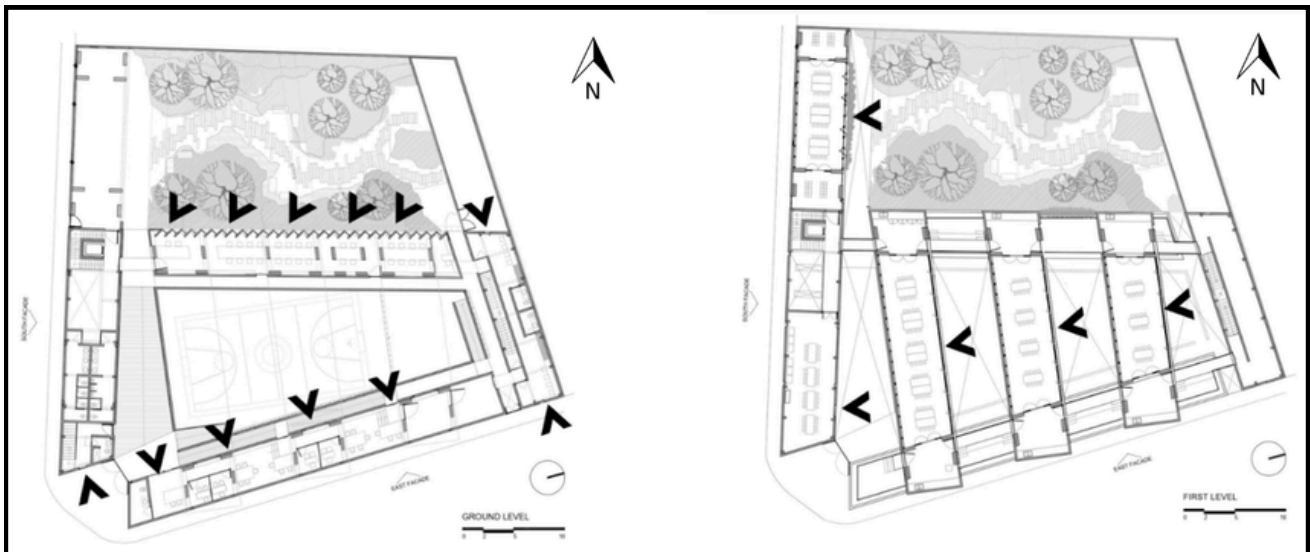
Planta de ubicación de ventanas del proyecto. Fuente: elaboración propia con base en ArchDaily México.
